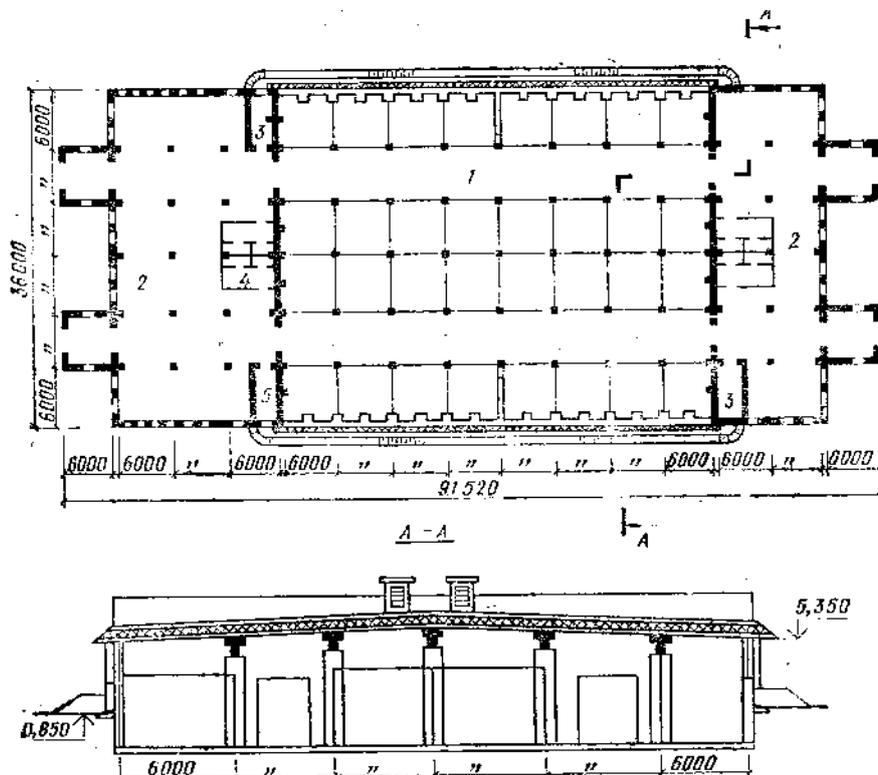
Секционное хранилище семенного картофеля вместимостью 3000 т с активной вентиляцией
